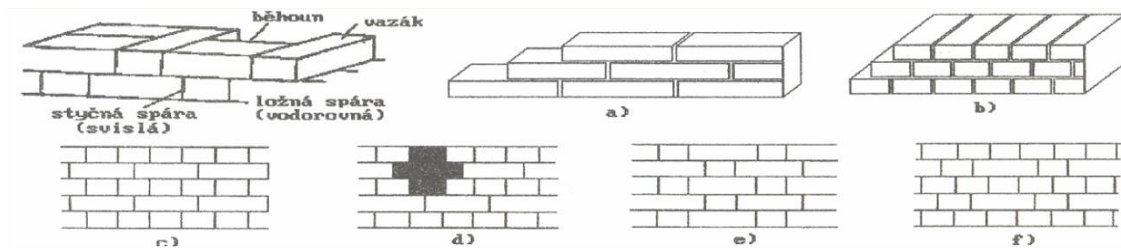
Roznos zatížení zděných konstrukcí (Vejvara, 2016).
